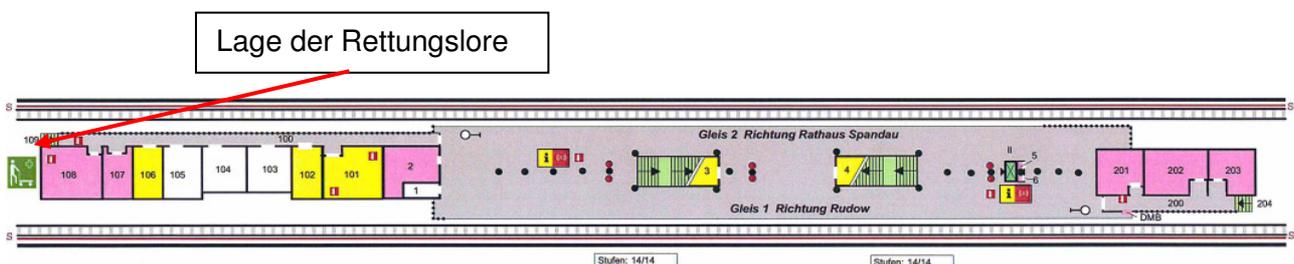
Ausschnitt aus dem Übersichtsplan U-Bahnhof Schönleinstraße mit Darstellung der prinzipiellen Lage der Rettungslore
